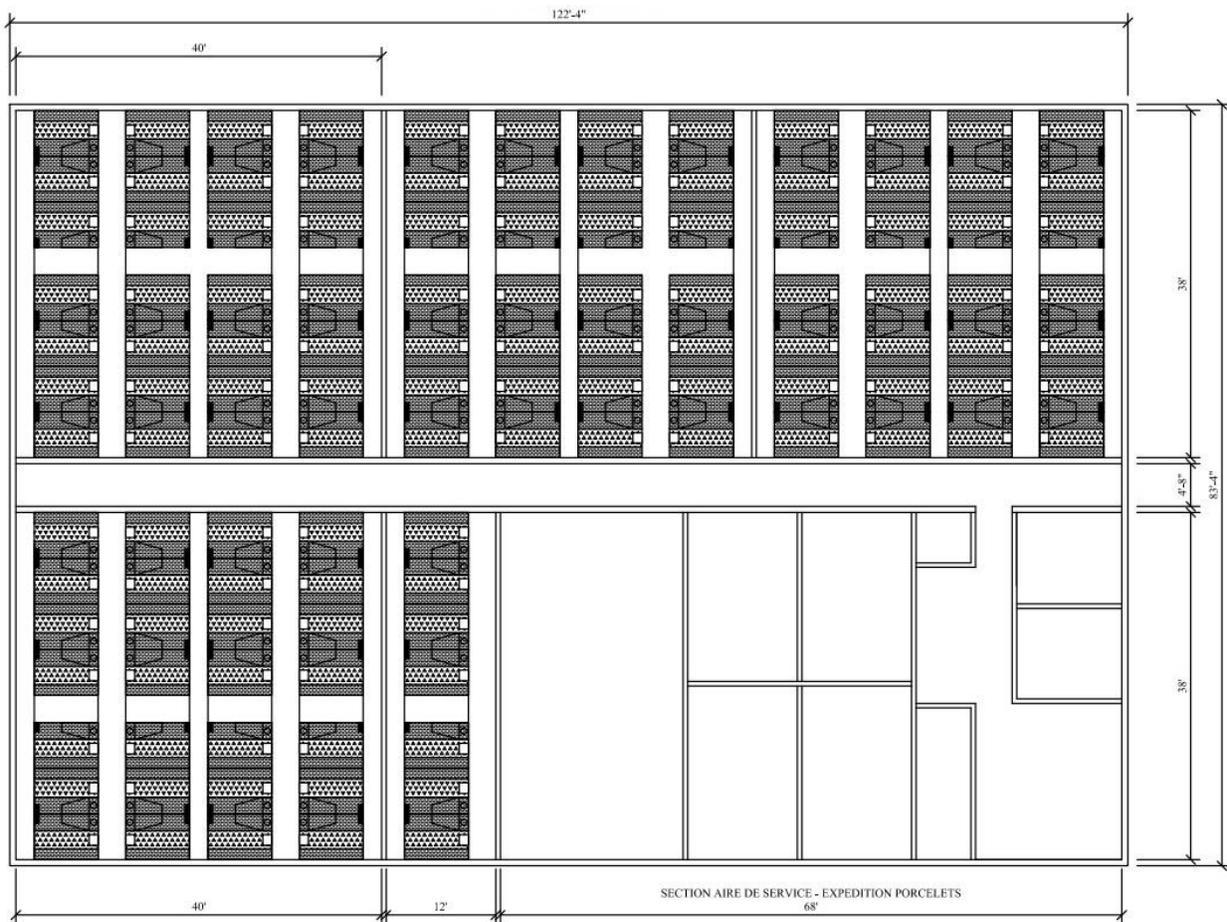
Plan initial de la section mise bas du bâtiment existant.
